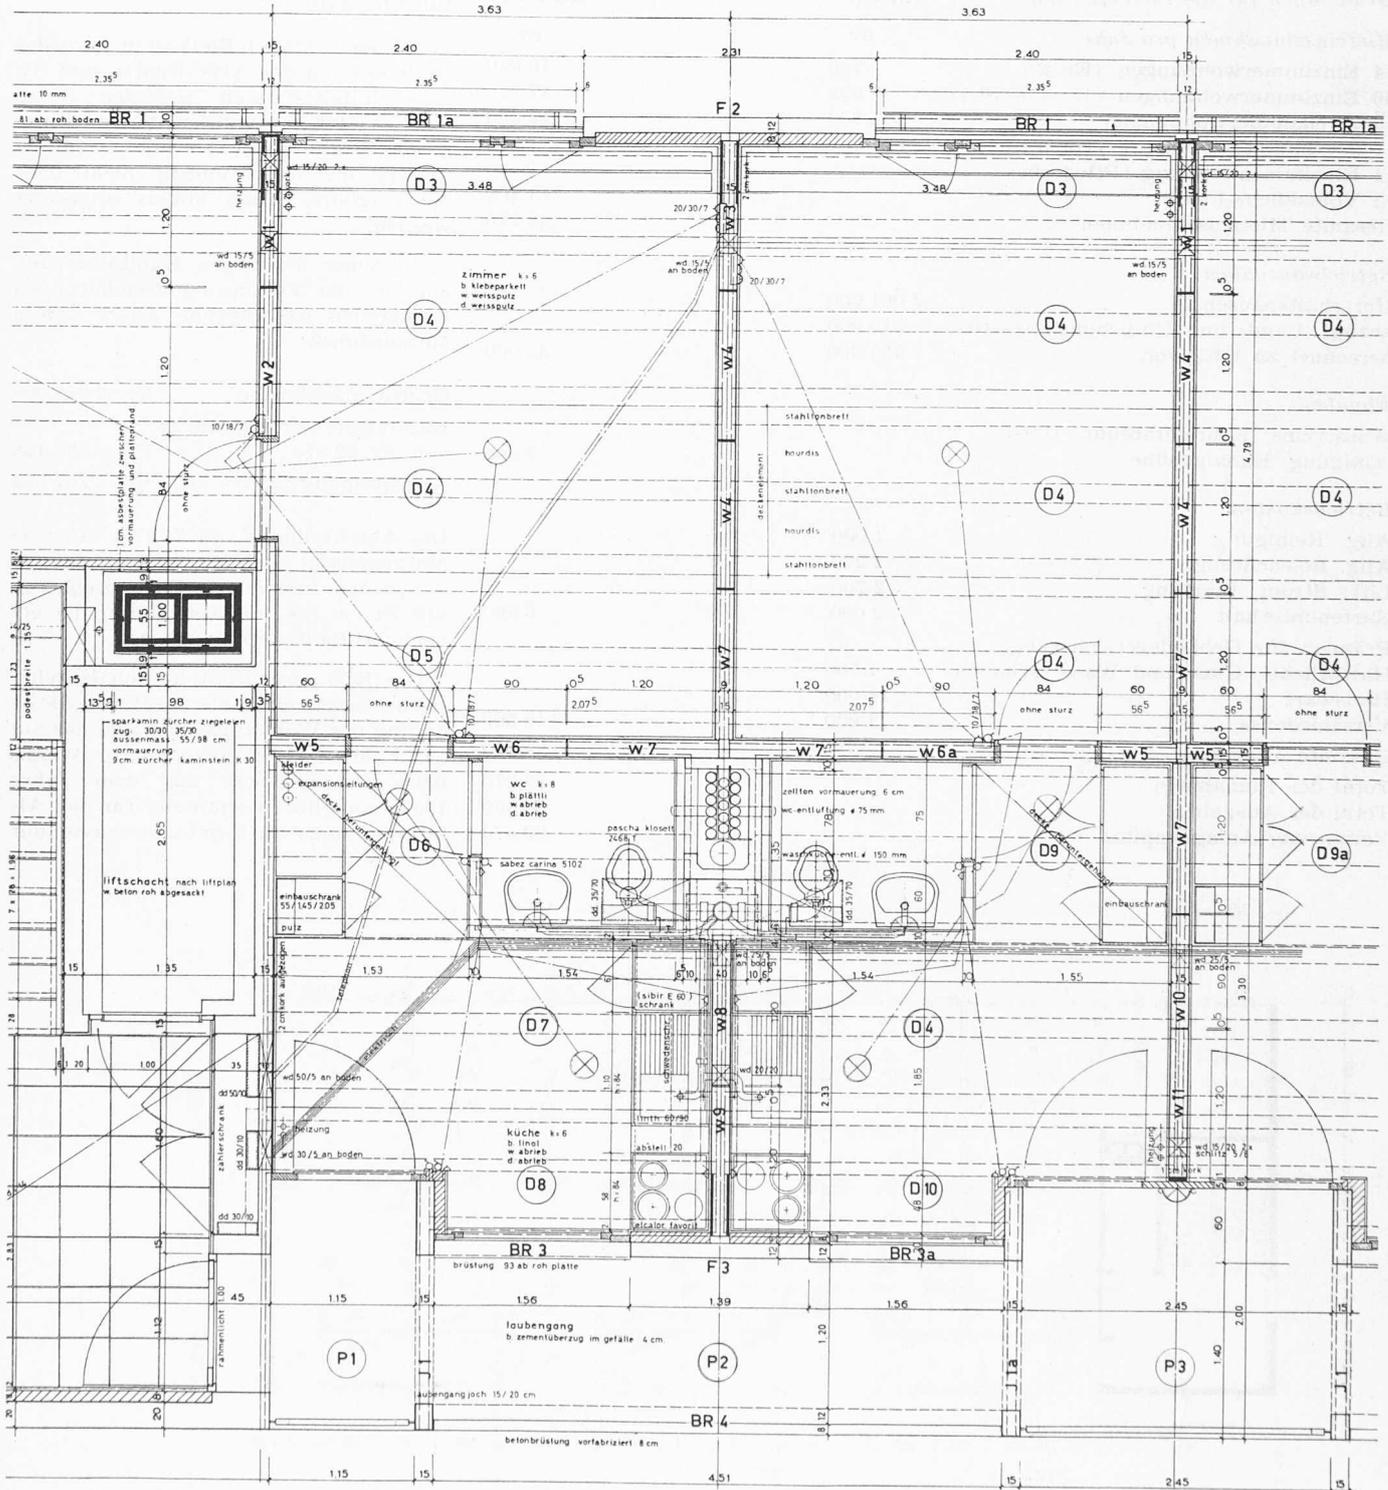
Ausschnitt Normalgeschoss im Hochhaus, Masstab 1:60 (Originalmasstab 1:20), mit Angabe sämtlicher Installationen
